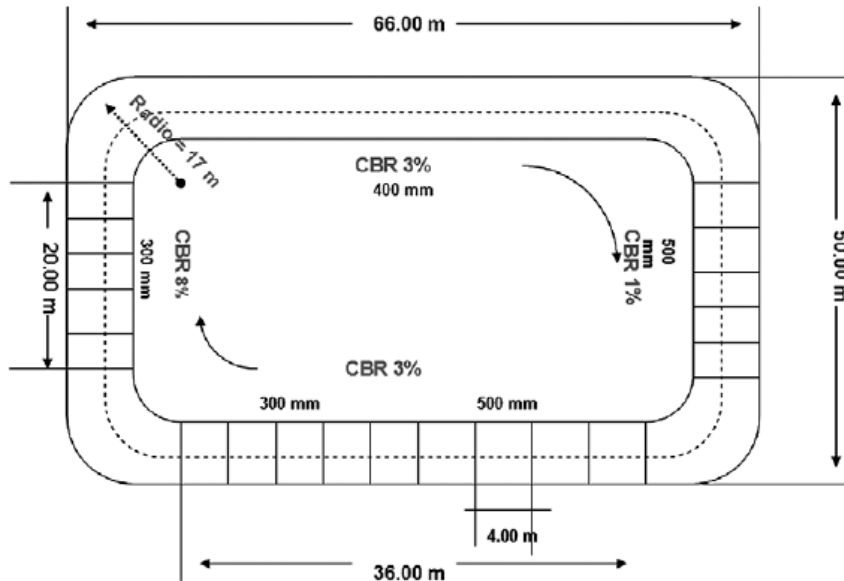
Vista de planta de la sección típica de la vía utilizada en el ensayo.
